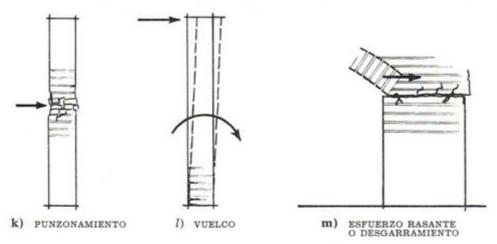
FISURAS EN LOS MUROS DE OBRA DE FABRICA
